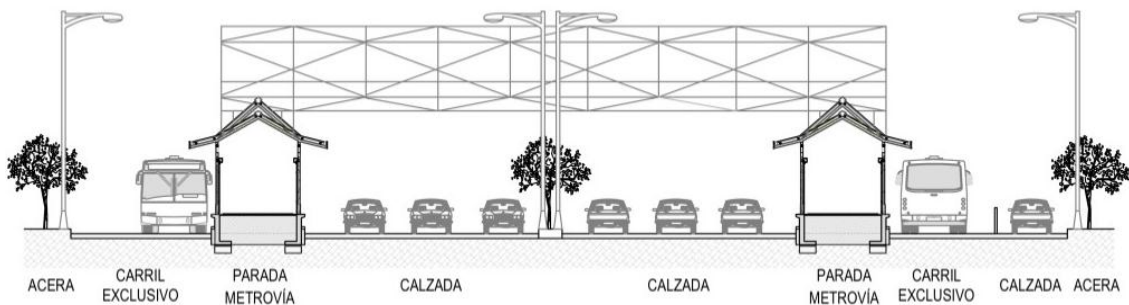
Sección parada Santa Leonor. Fuente: Naranjo, 2017
